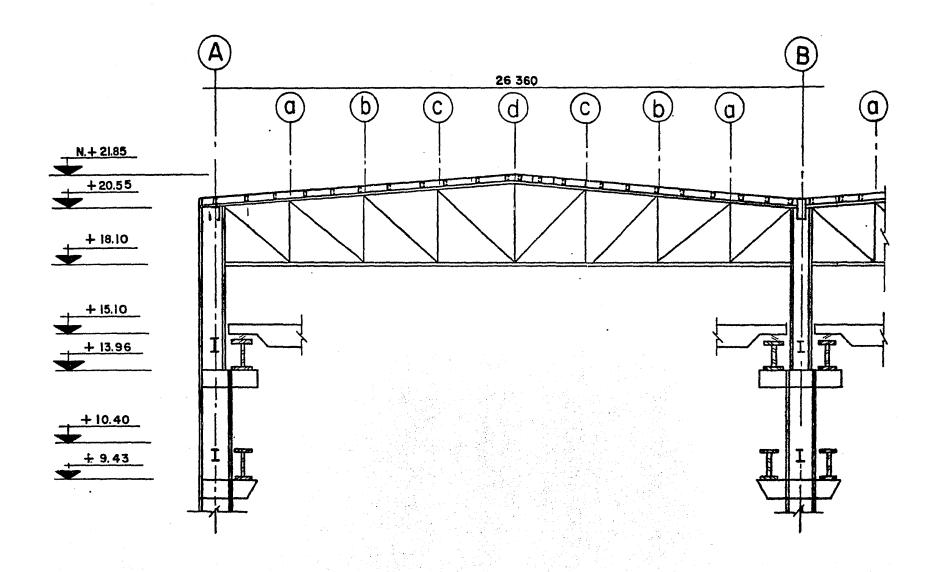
ARMADURAS PRINCIPALES Y TRABES CARRIL
